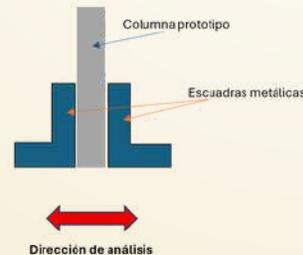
Esquema de unión de las columnas del prototipo y escuadras metálicas
